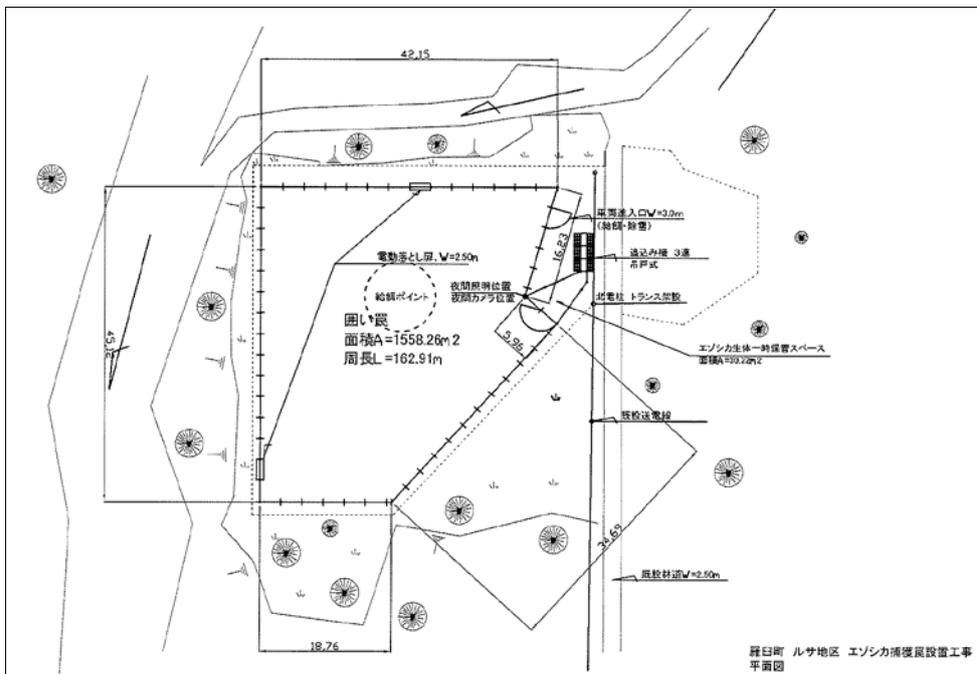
改修前のルサ大型囲いわなの平面図
